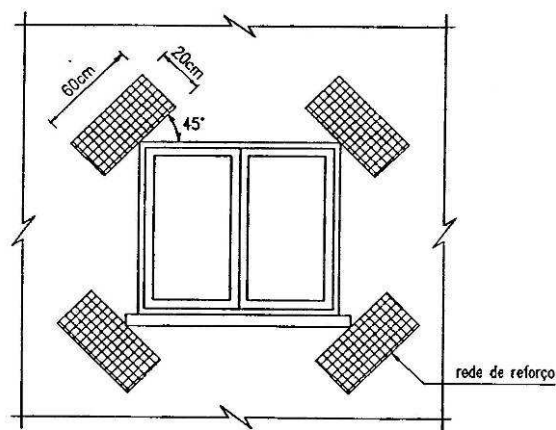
Armadura de rede de fibra de vidro em zonas vulneráveis à fissuração de um reboco exterior
